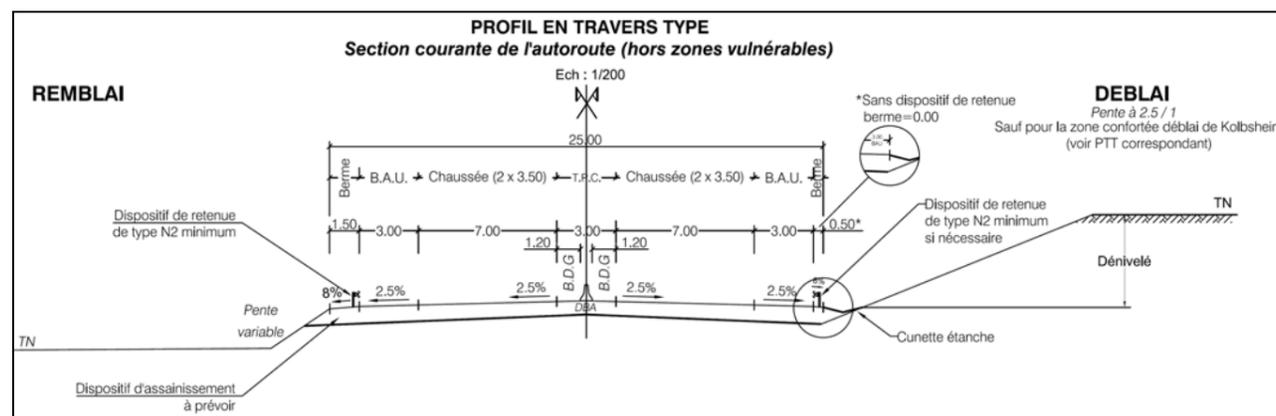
Profil en travers type du projet (section courante de l'autoroute en dehors des zones vulnérables)
